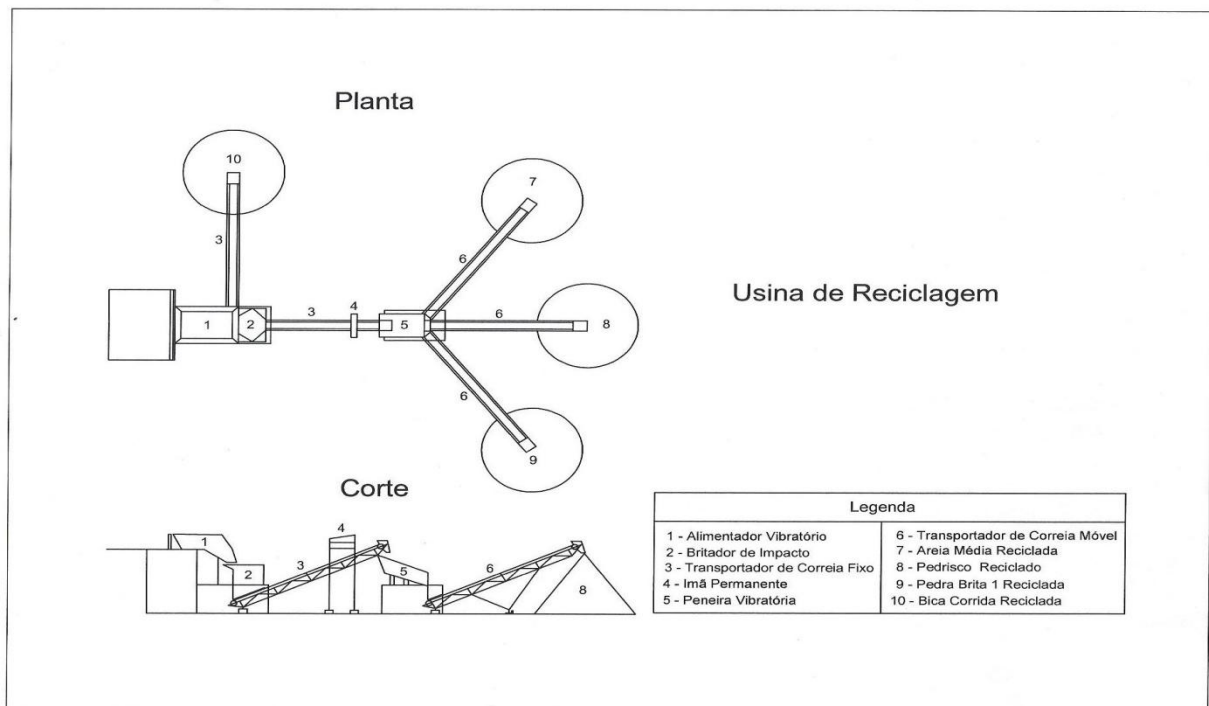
Layout projetado para a instalação da usina de reciclagem.
